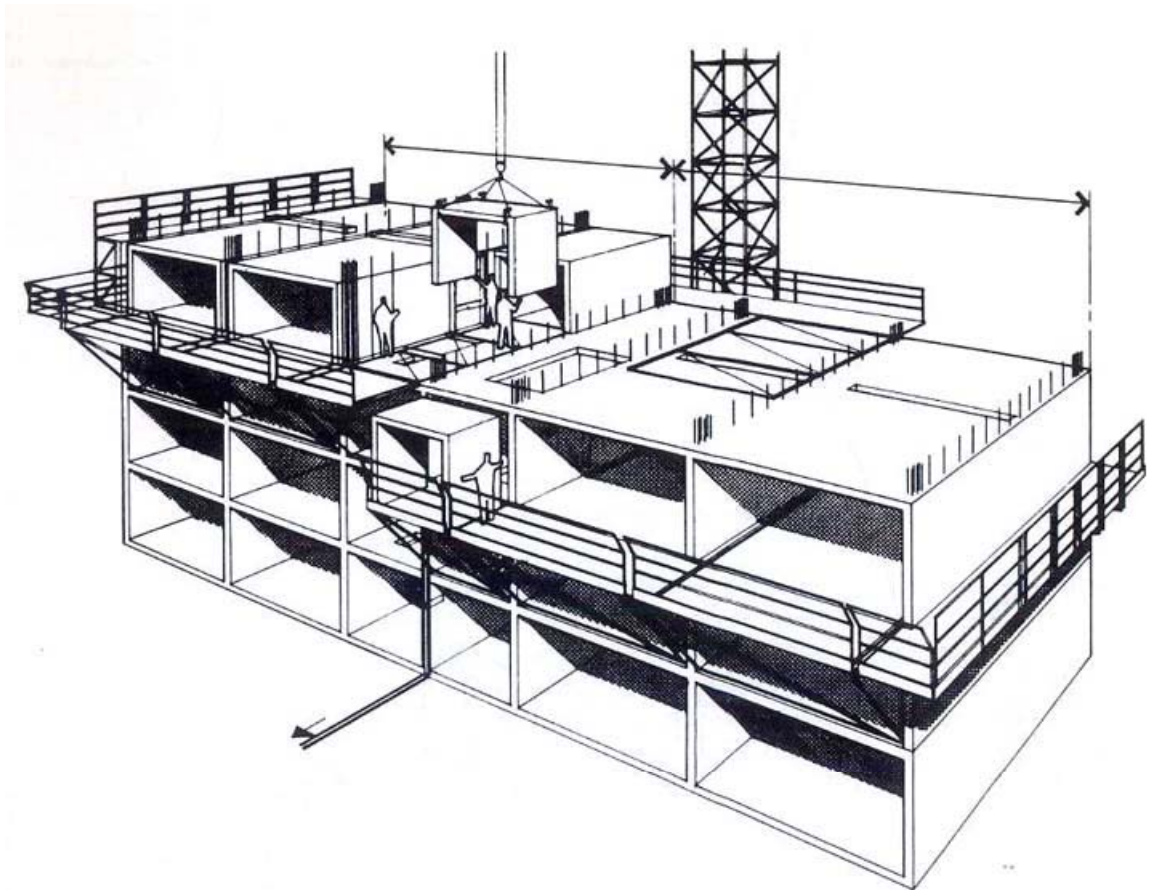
Técnicas especiales de construcción. Ilustra el "edificios que se construye solo". Con la técnica de encofrado Tunnel<sup>17</sup>
